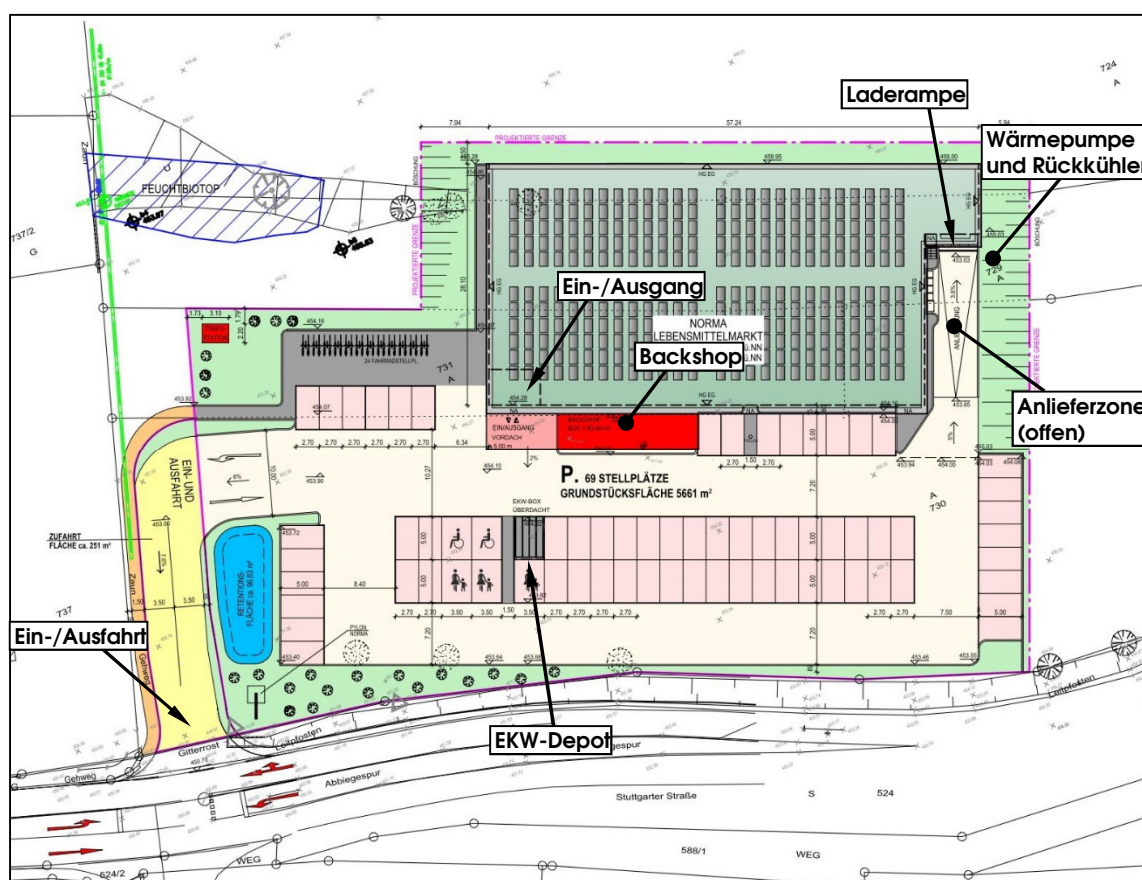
Lageplan, geplanter NORMA - Markt, ohne Maßstab
